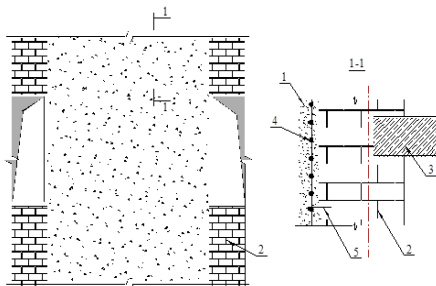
Конструктивное решение усиления стен из каменной кладки железобетонными аппликациями:
